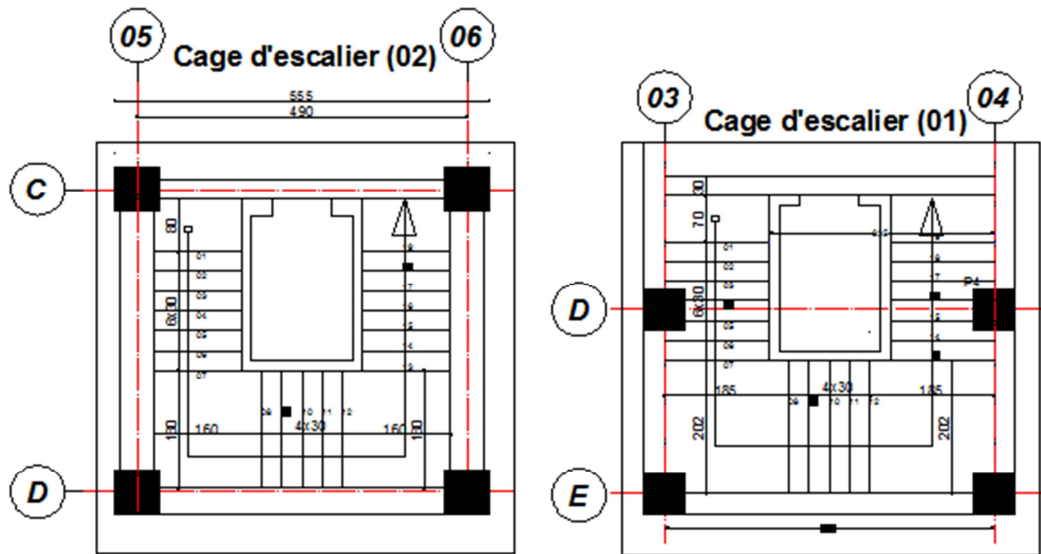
Vue en plan des deux cage d’escalier
